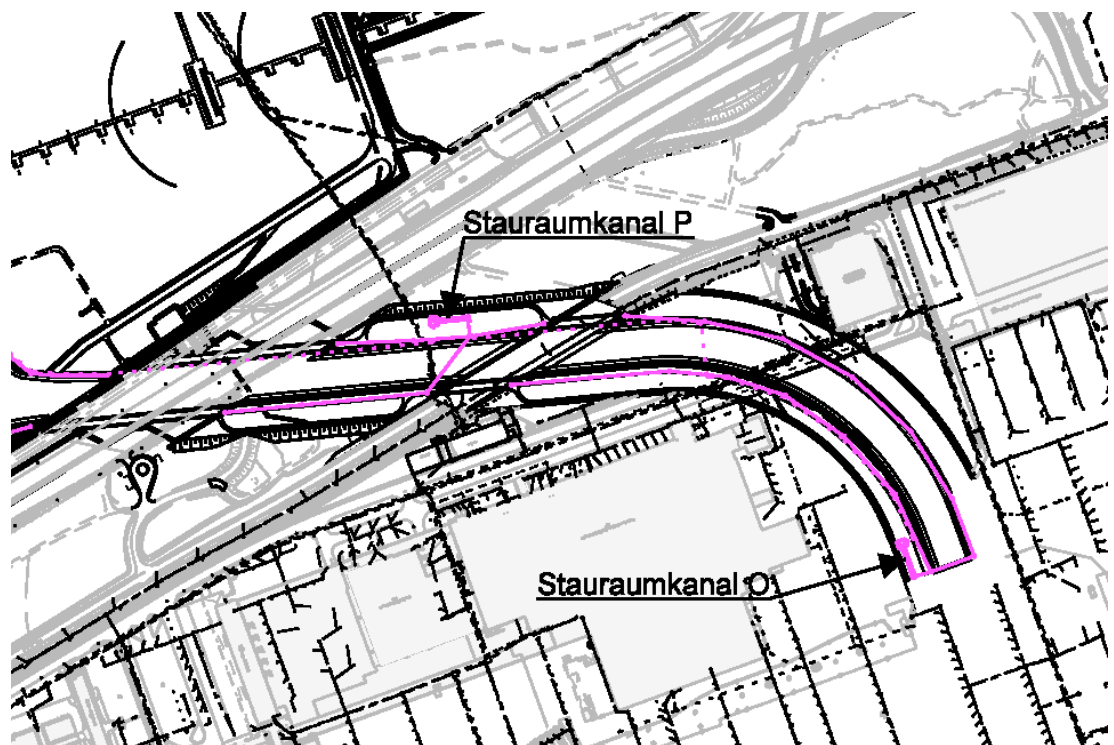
Lageplanausschnitt Stauraumkanäle
